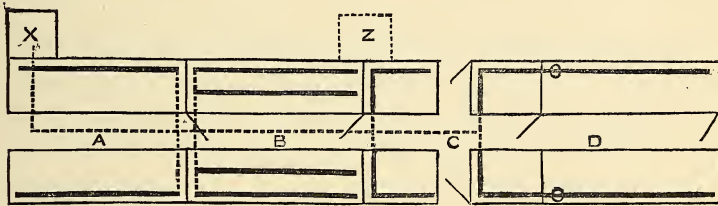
Plan ou disposition de générateur et de conduites d'eau chaude.
